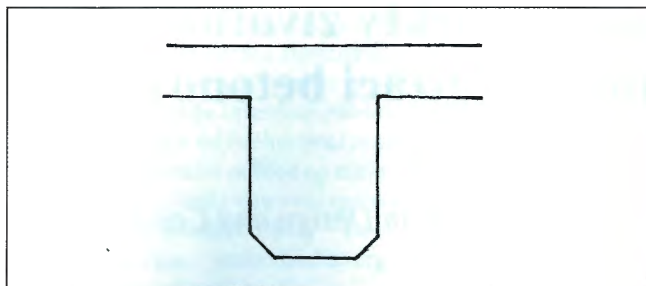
Napjatost při odprýsknutí betonu / Stresses by concrete spalling
